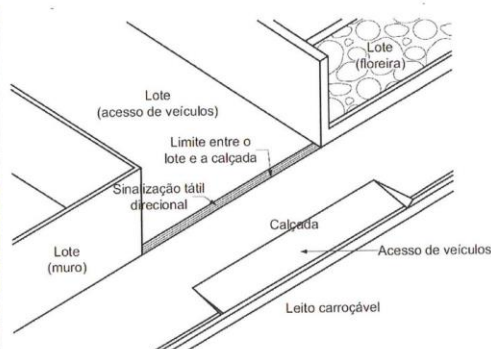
Alinhamento de lote não edificado, entre outros lotes edificados (Figura 61 da NBR 16537/2016)
